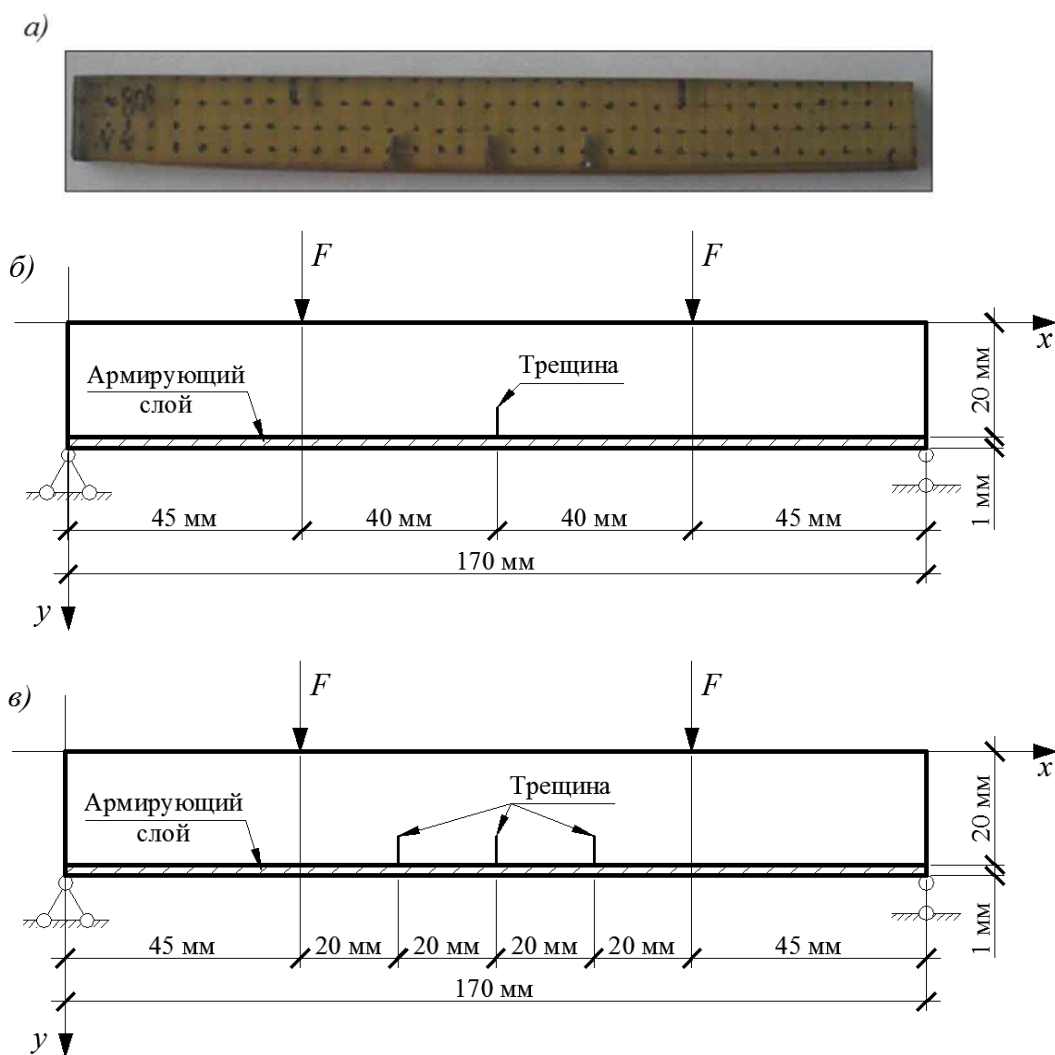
Опытный образец с тремя трещинами (а);
